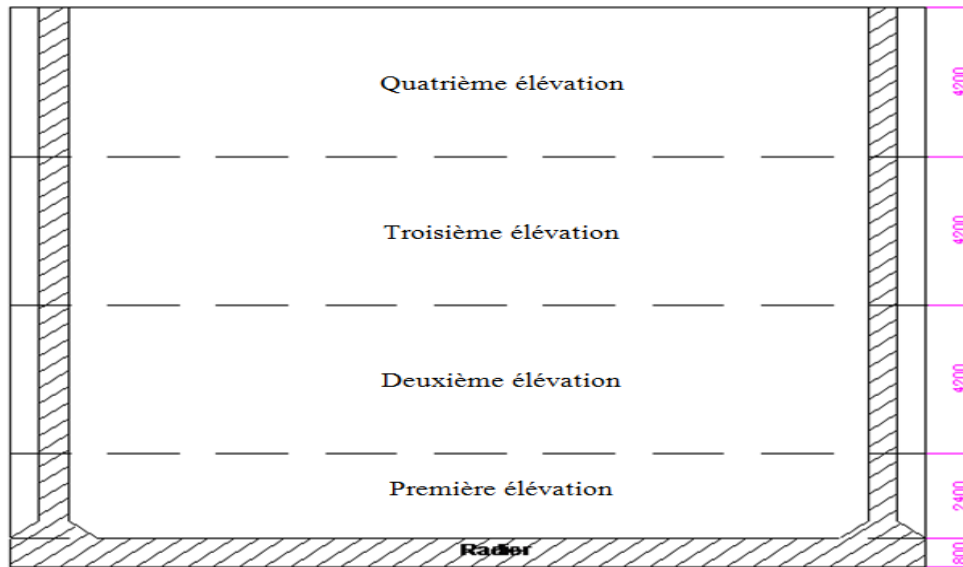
Plan de coulage d'un caisson en élévations.
